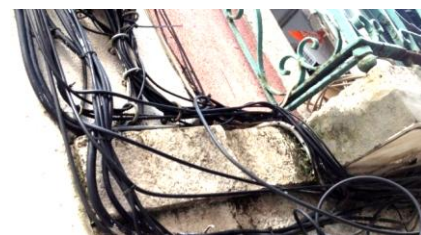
Exemplo de erros cometidos fachadas Pombalinas na Baixa Chiado Lisboa, Registo do autor.
